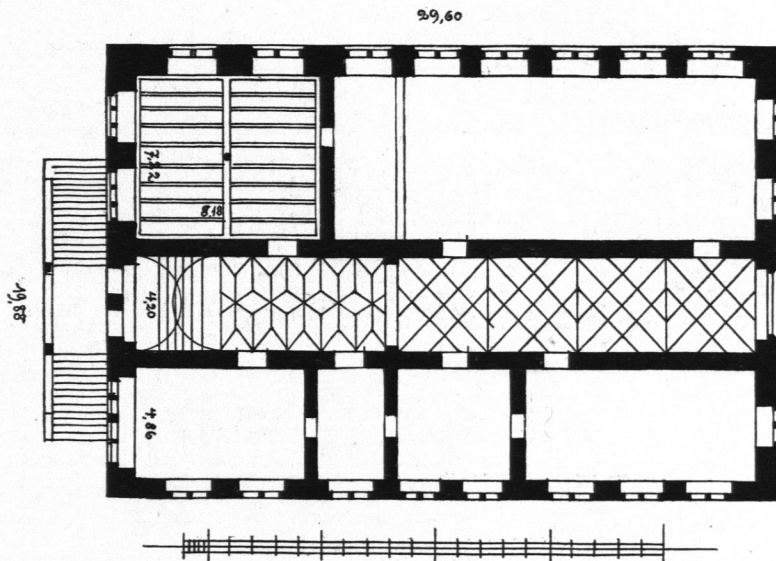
Rathaus zu Mauen. Grundriß des Erdgeschößes.
